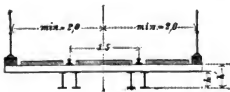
u. 258. Fahrbahn von Straßenbrücken. Hohe Konstruktion.
